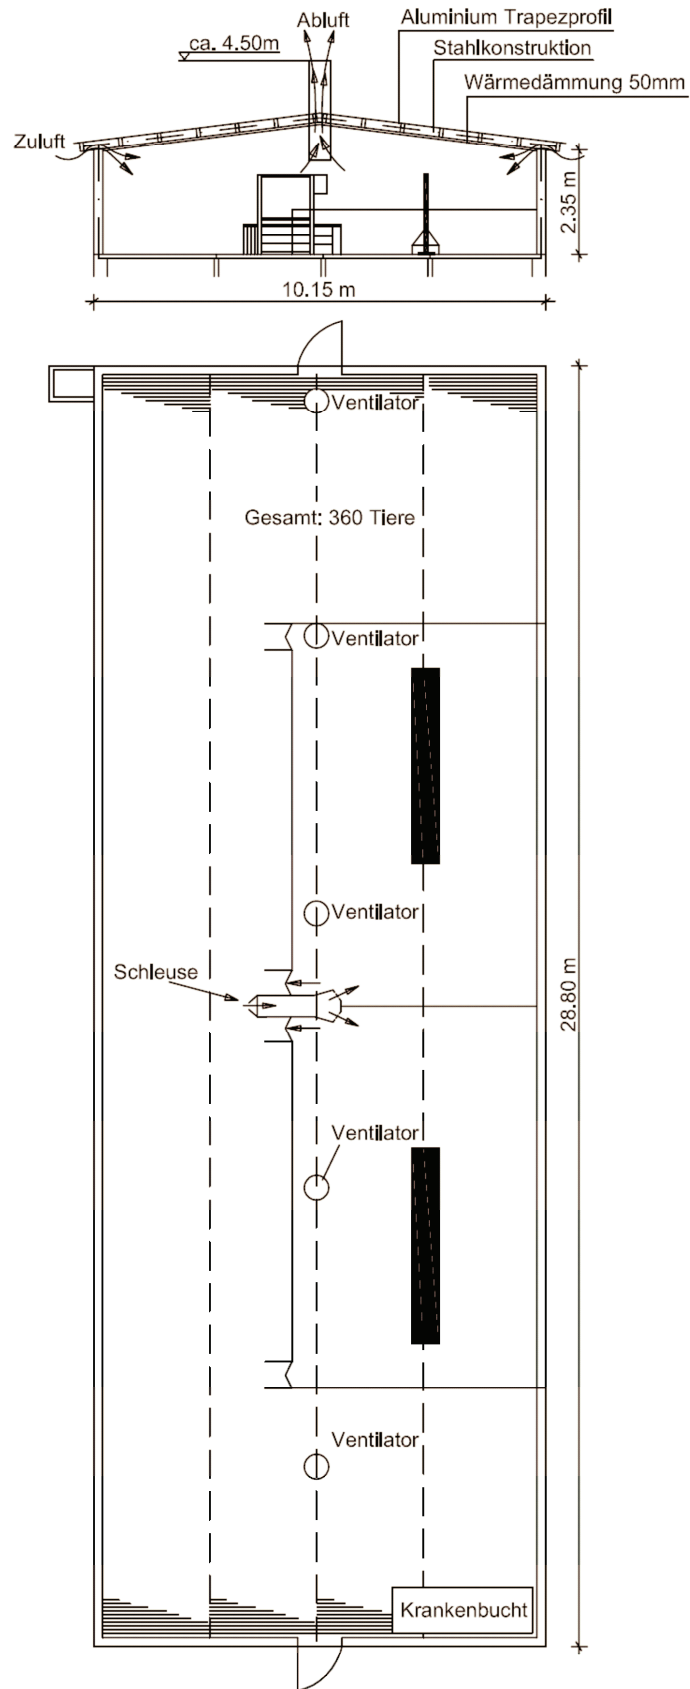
Querschnitt und Grundriss des Versuchsstalles
